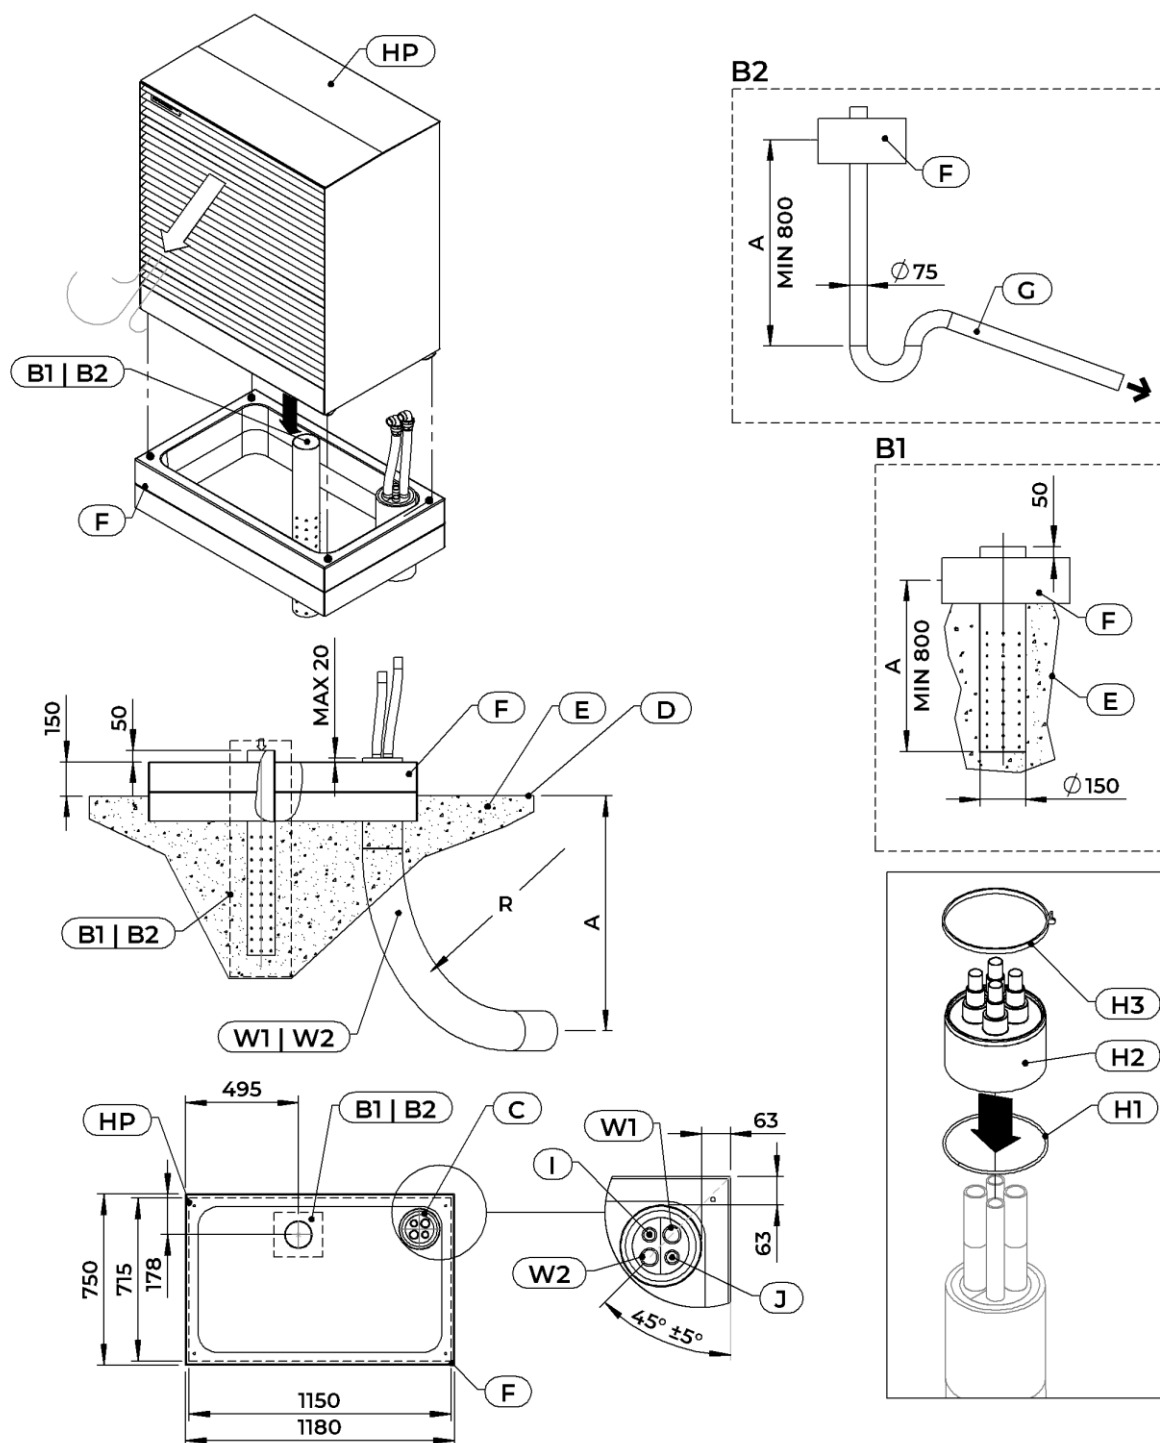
Vorgefertigtes Betonfundament ZBT_ADAPT 2, Rohranschluss unterirdisch
